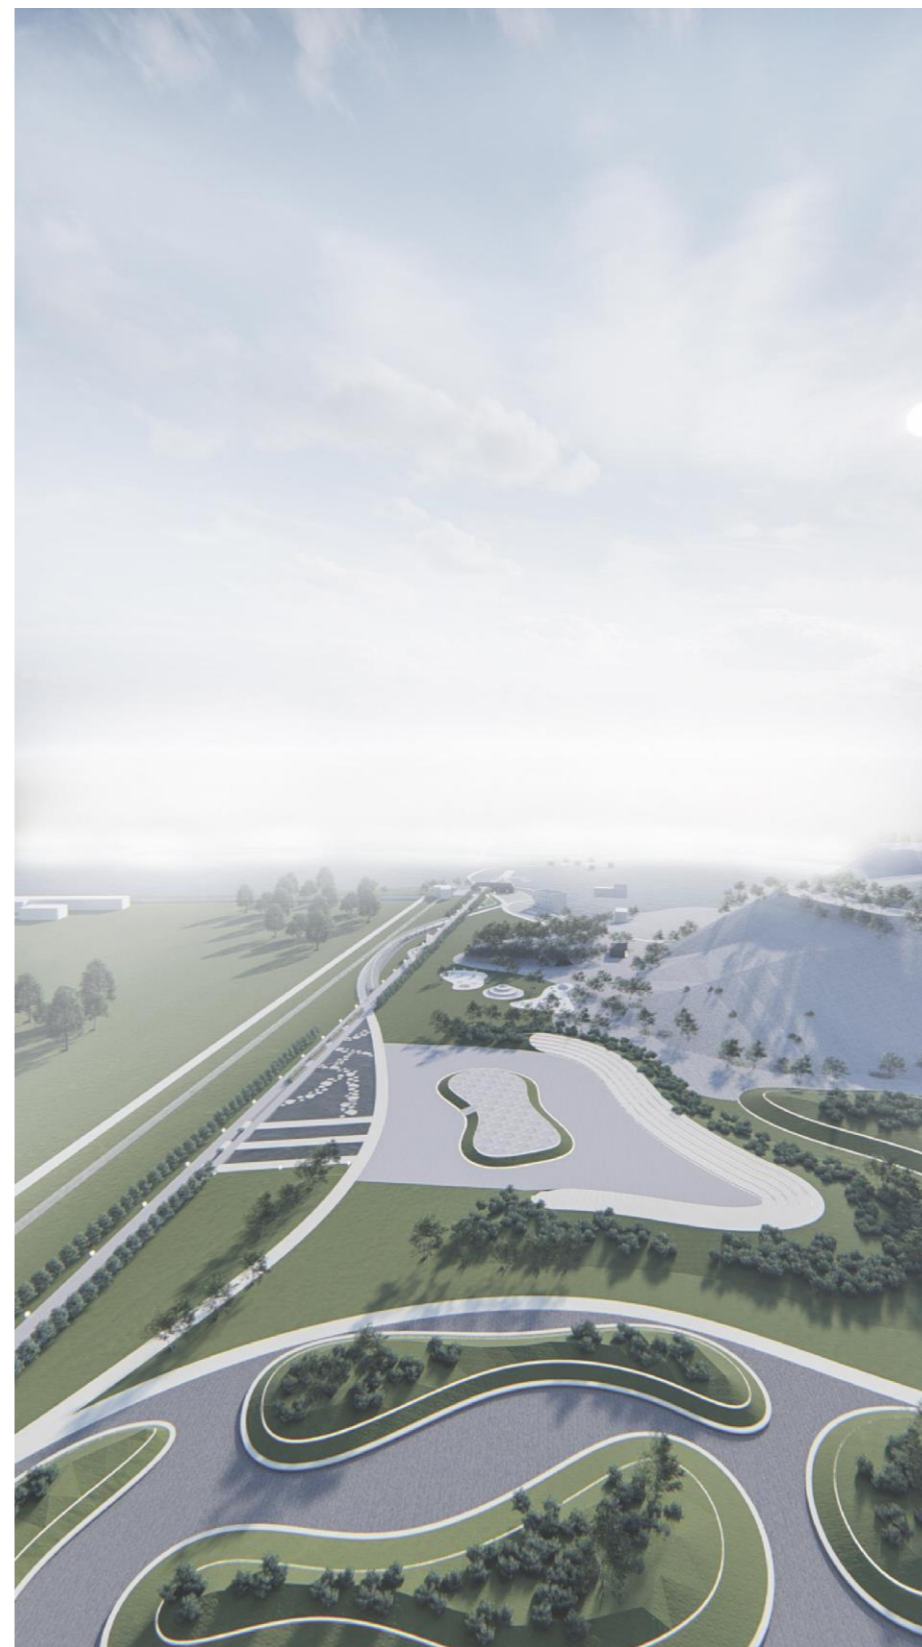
Vaade planeeritavale alale põhjast (autori joonis)
